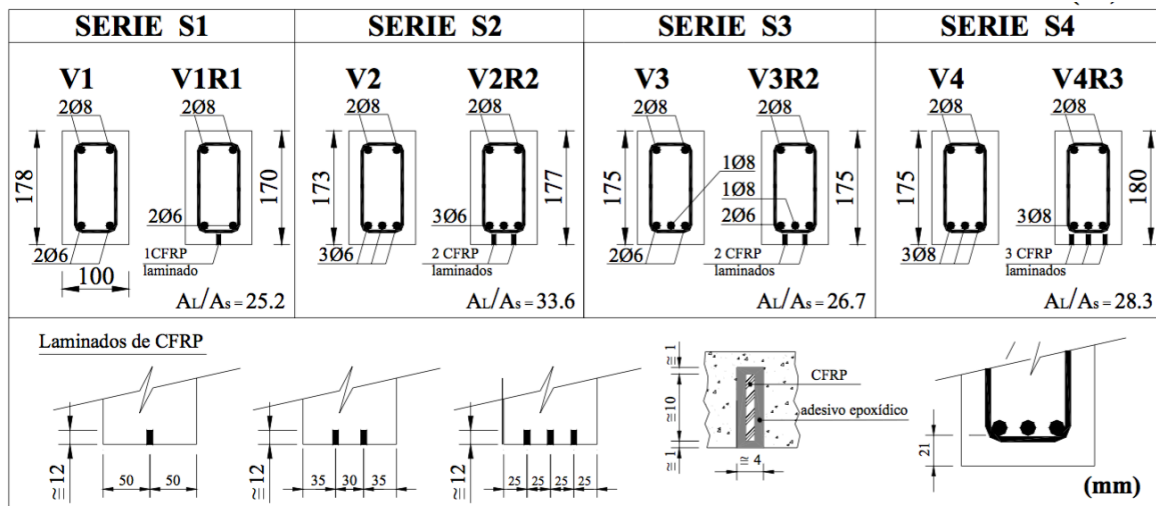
Seção transversal das vigas (Fonte: Fortes *et al*, 2002)
